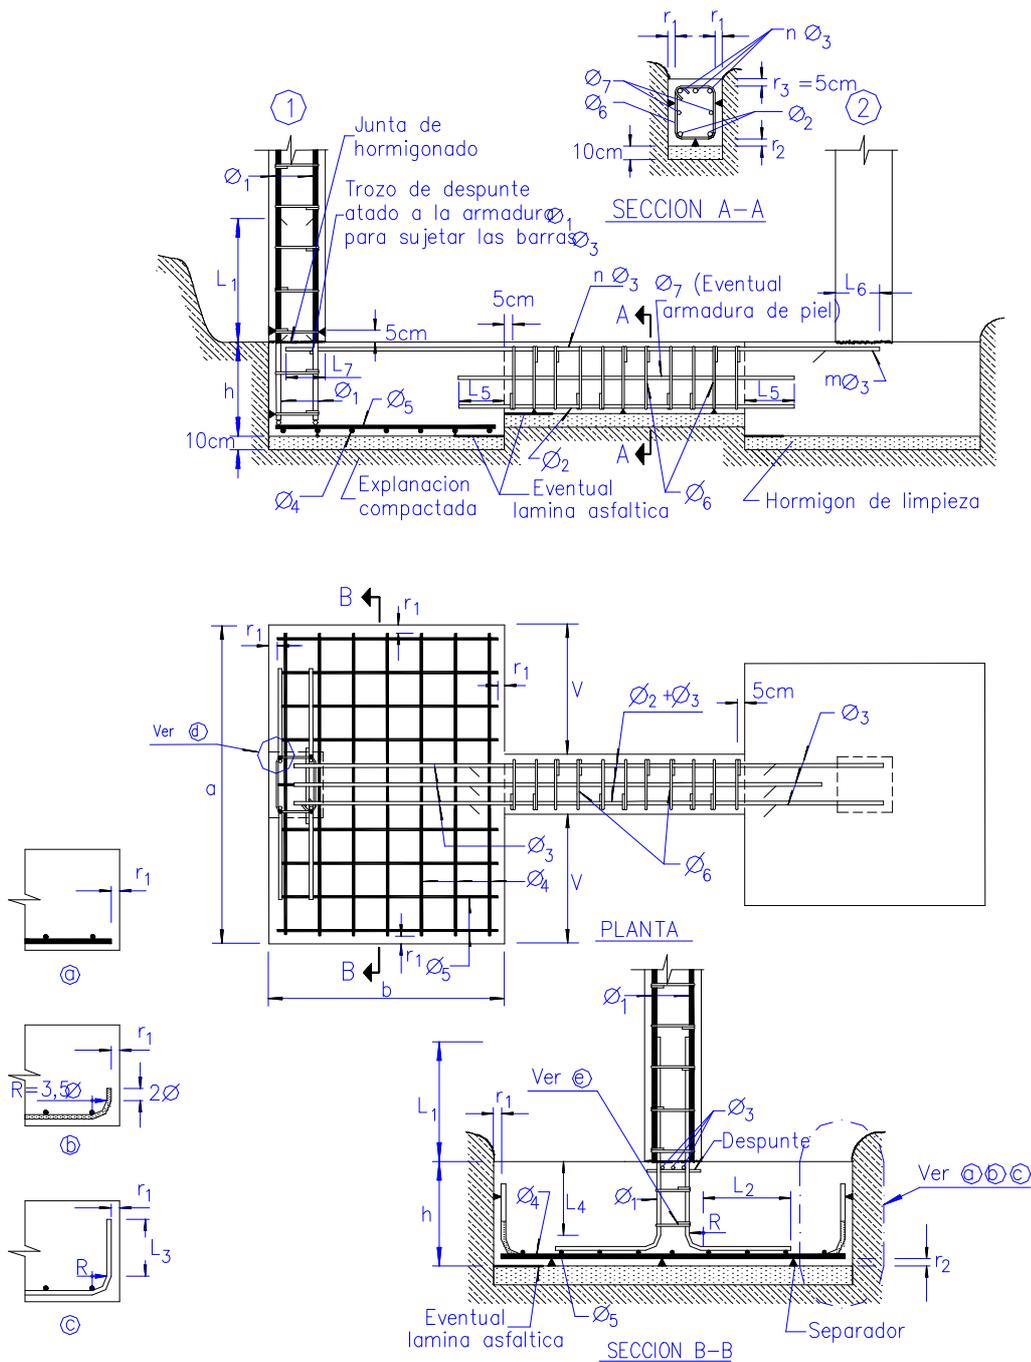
Zapata medianera con viga centradora (Ref ZM1)
